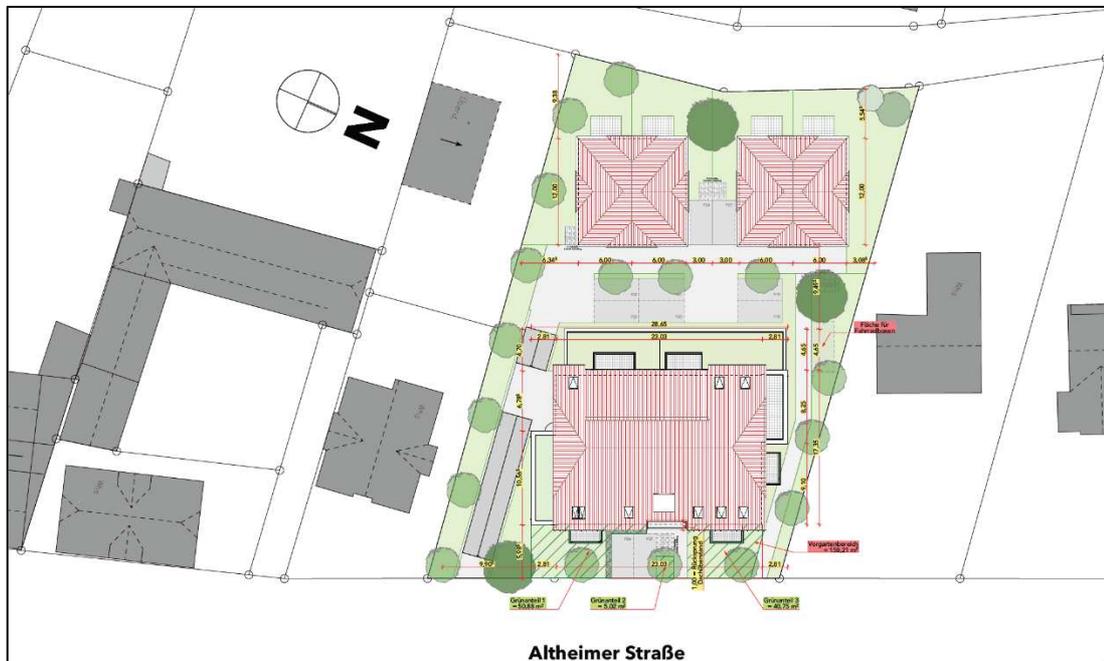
Freiflächenplan Entwurfsplanung vom 22.09.2022 SAM Hochbau Planung GmbH, Babenhausen
